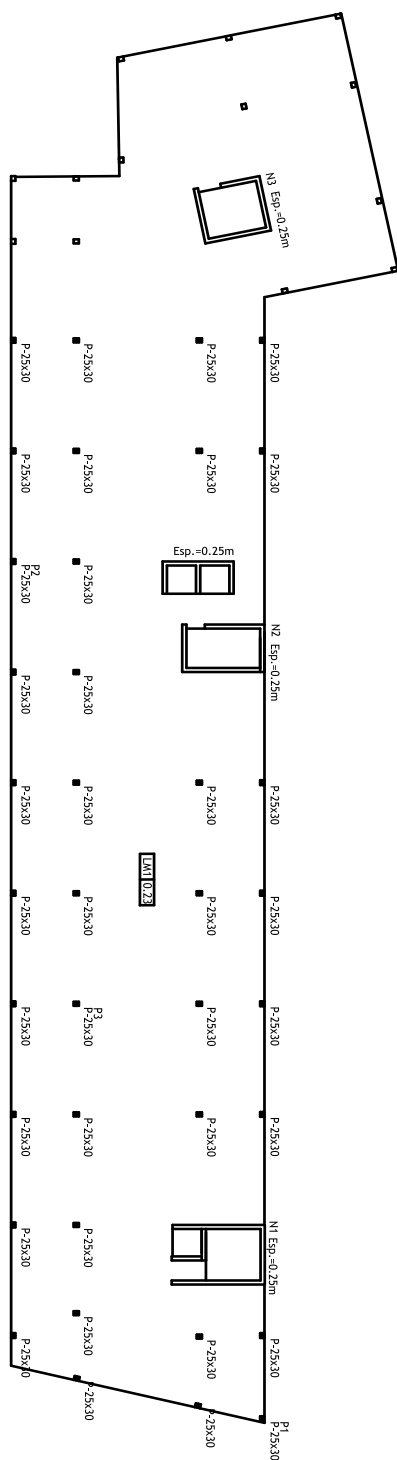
Edifício real: planta estrutural do piso 6
